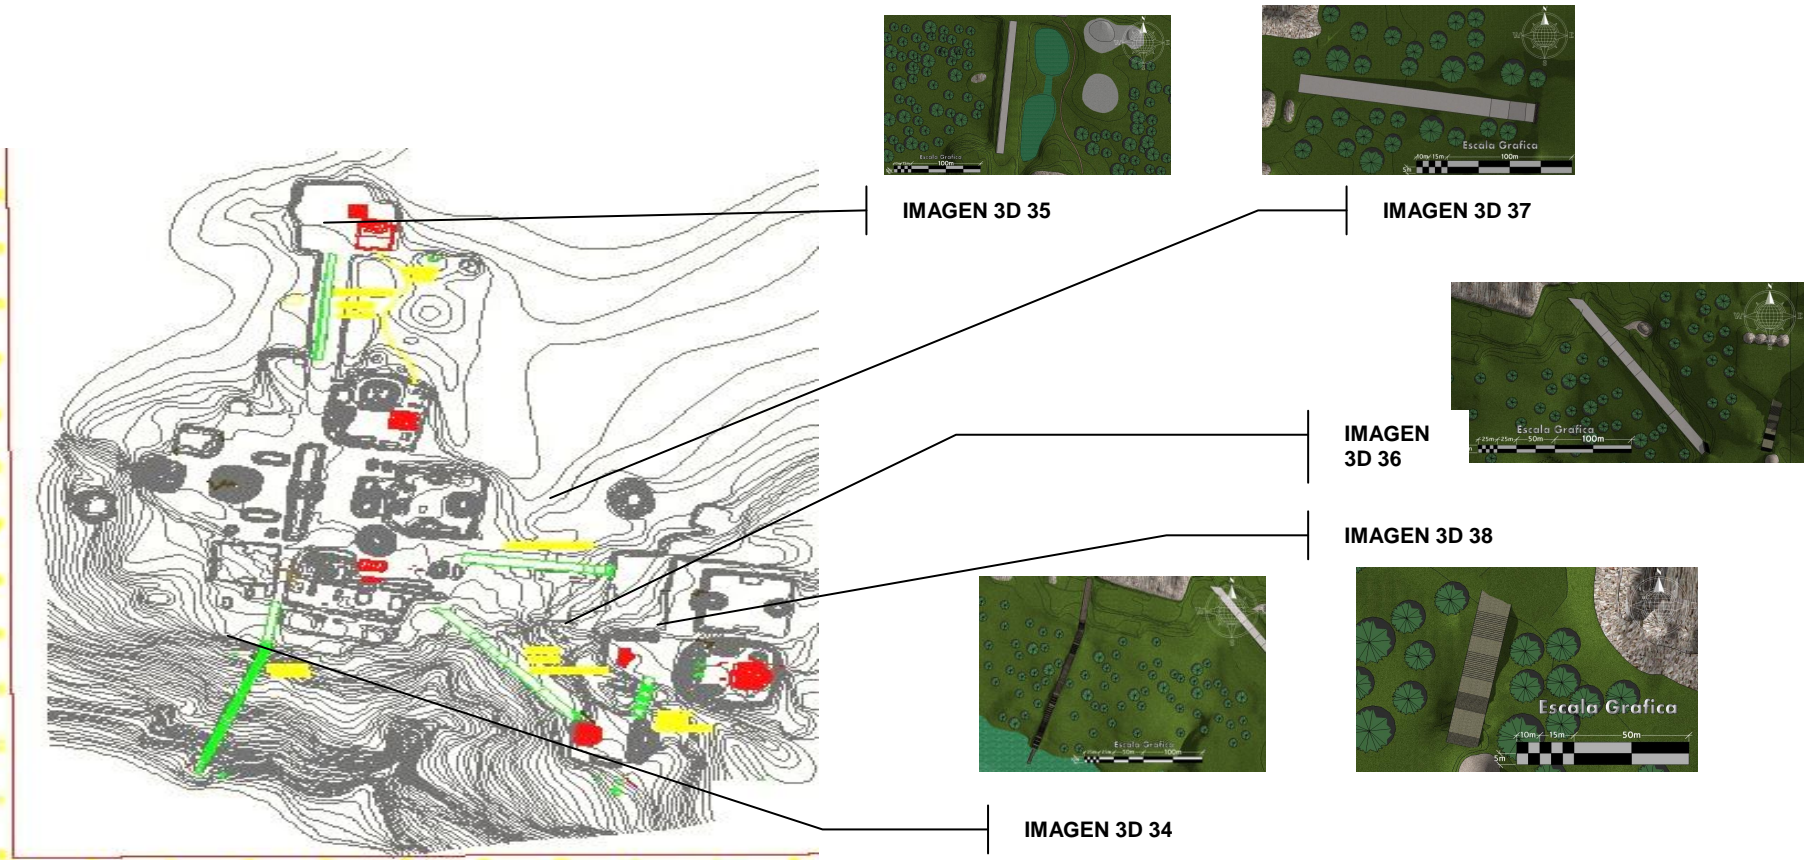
PLANTA AUTO-CAD Segunda Etapa Constructiva de las Calzadas de Yaxhá.
